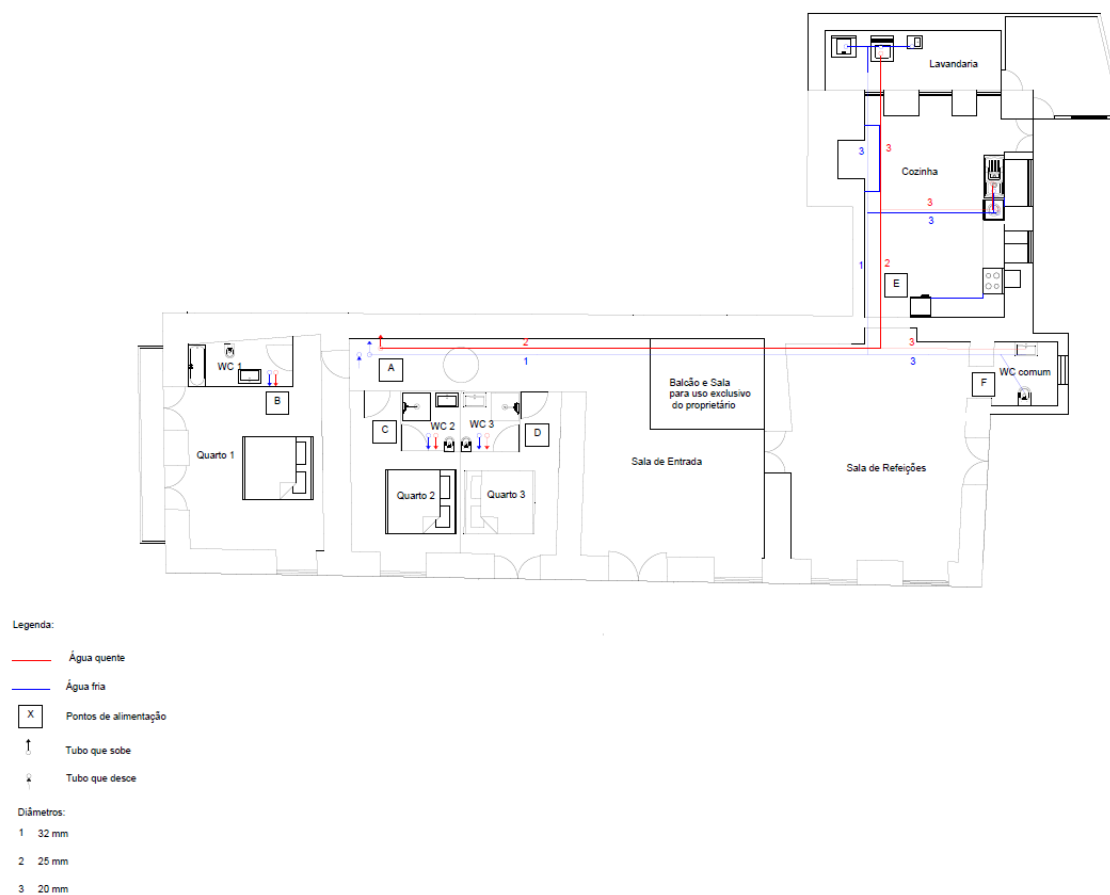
Rede de Abastecimento de Águas – Planta do R/C.
